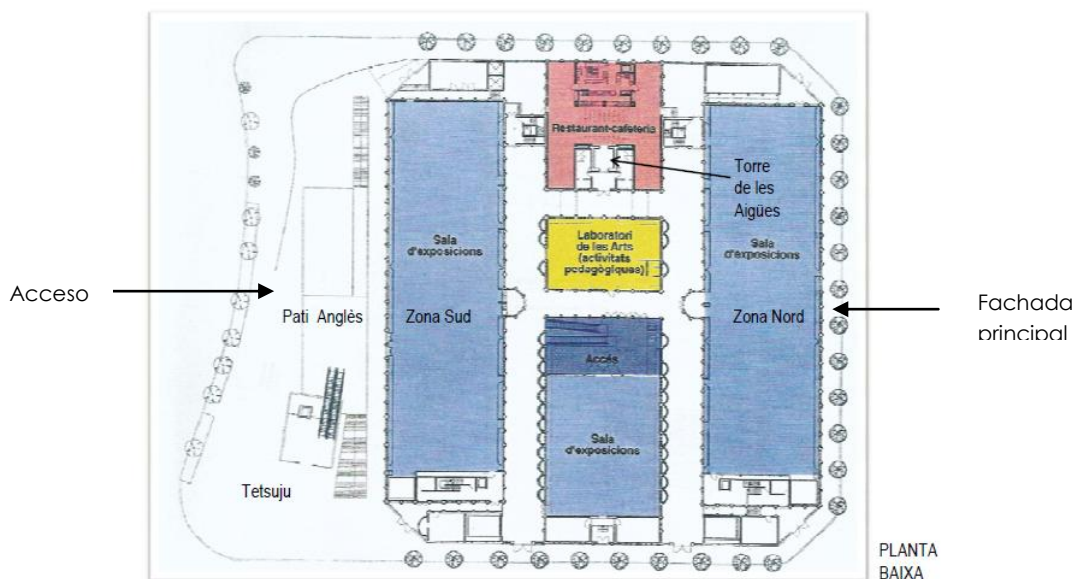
Esquema de la distribución actual en planta baja (Fuente: David Lladó i Porta)
